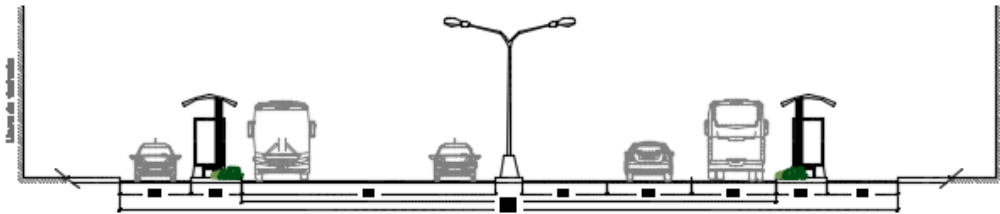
Propuesta Perfil Avenida Bahía (2018)
